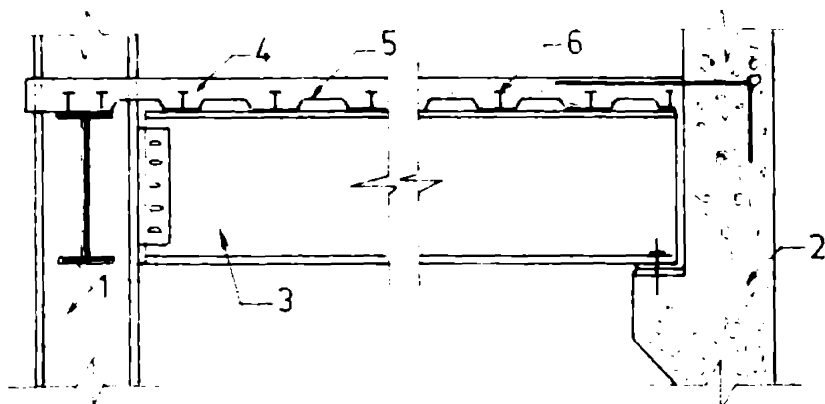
10 1-Grindă și stîlp oțel, cadru exterior. 2-Diafragmă centrală 3-Grindă oțel planșeu. 4-Placă beton armat 5-Cofraj pieraut tablă cutată 6-Elemente de legatură dornuri
